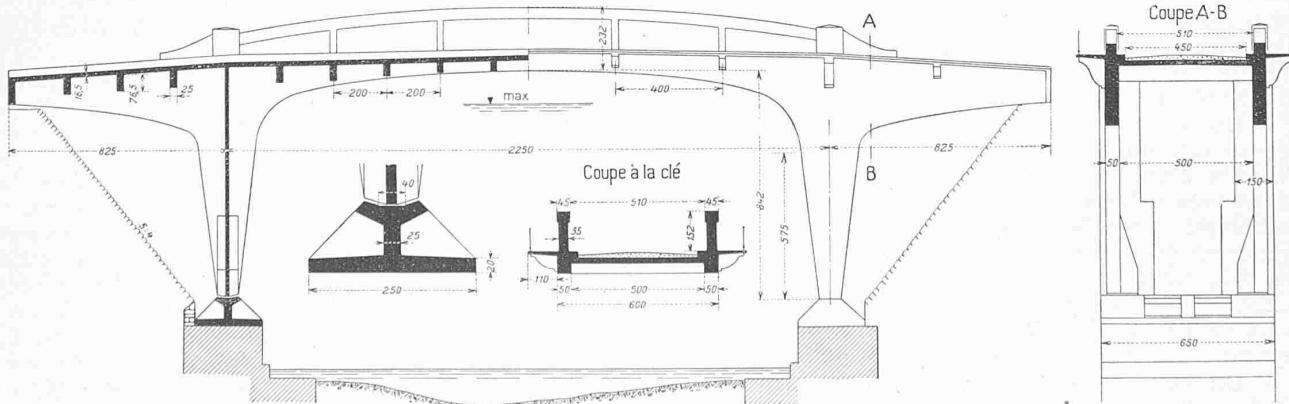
Elévation générale et coupes longitudinale, vers l'appui (A-B) et la clé, échelle 1 : 250. — Detail de l'articulation 1 : 100.
